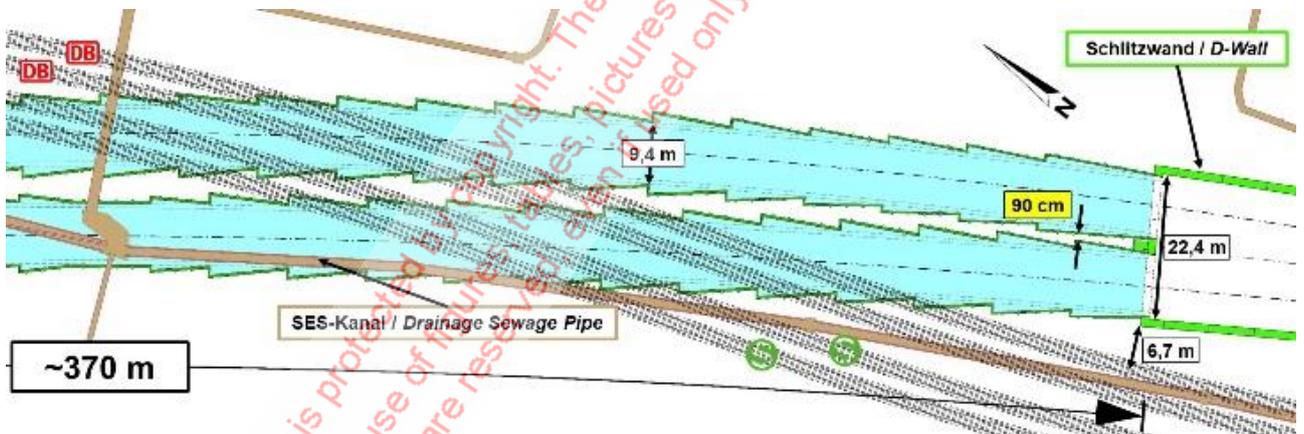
Unterfahrung Bruckwiesenwegbrücke und DB-Strecke, Lageplan, Teil Süd
